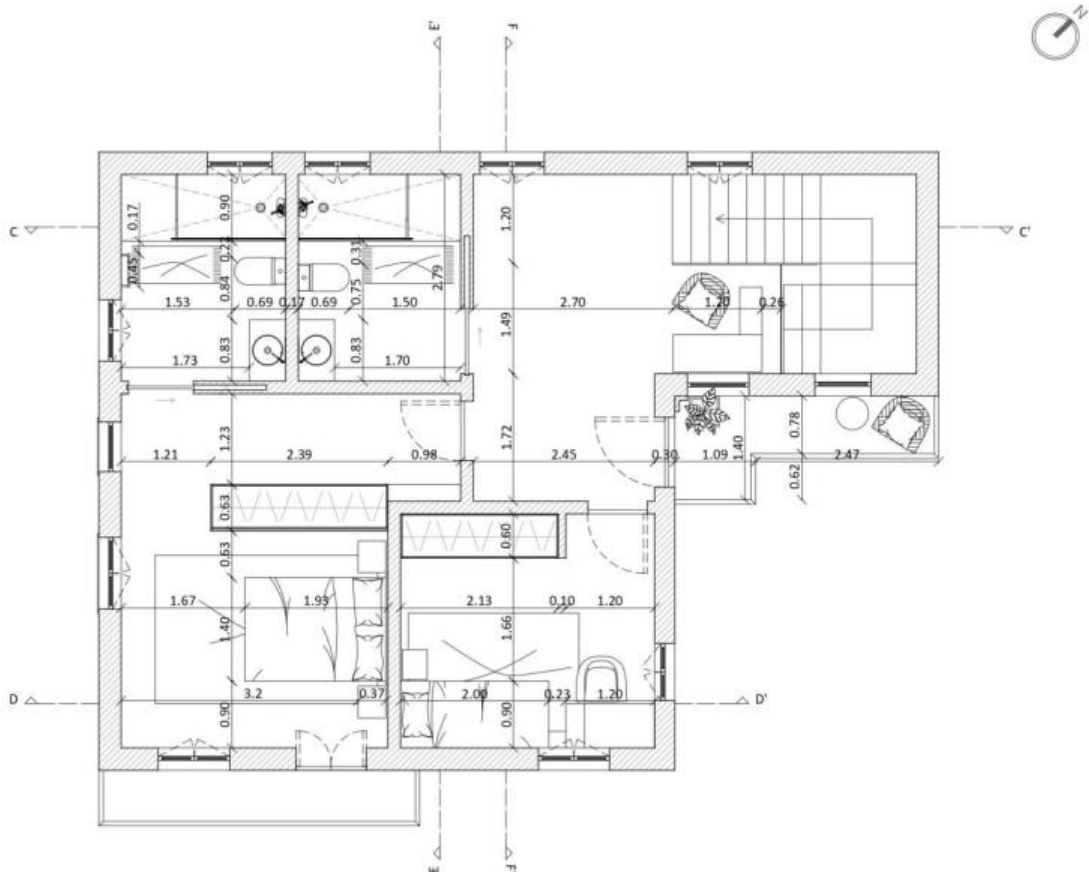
Planta de Equipamento e Mobiliário cotada, Piso 1. Fonte: Autor
